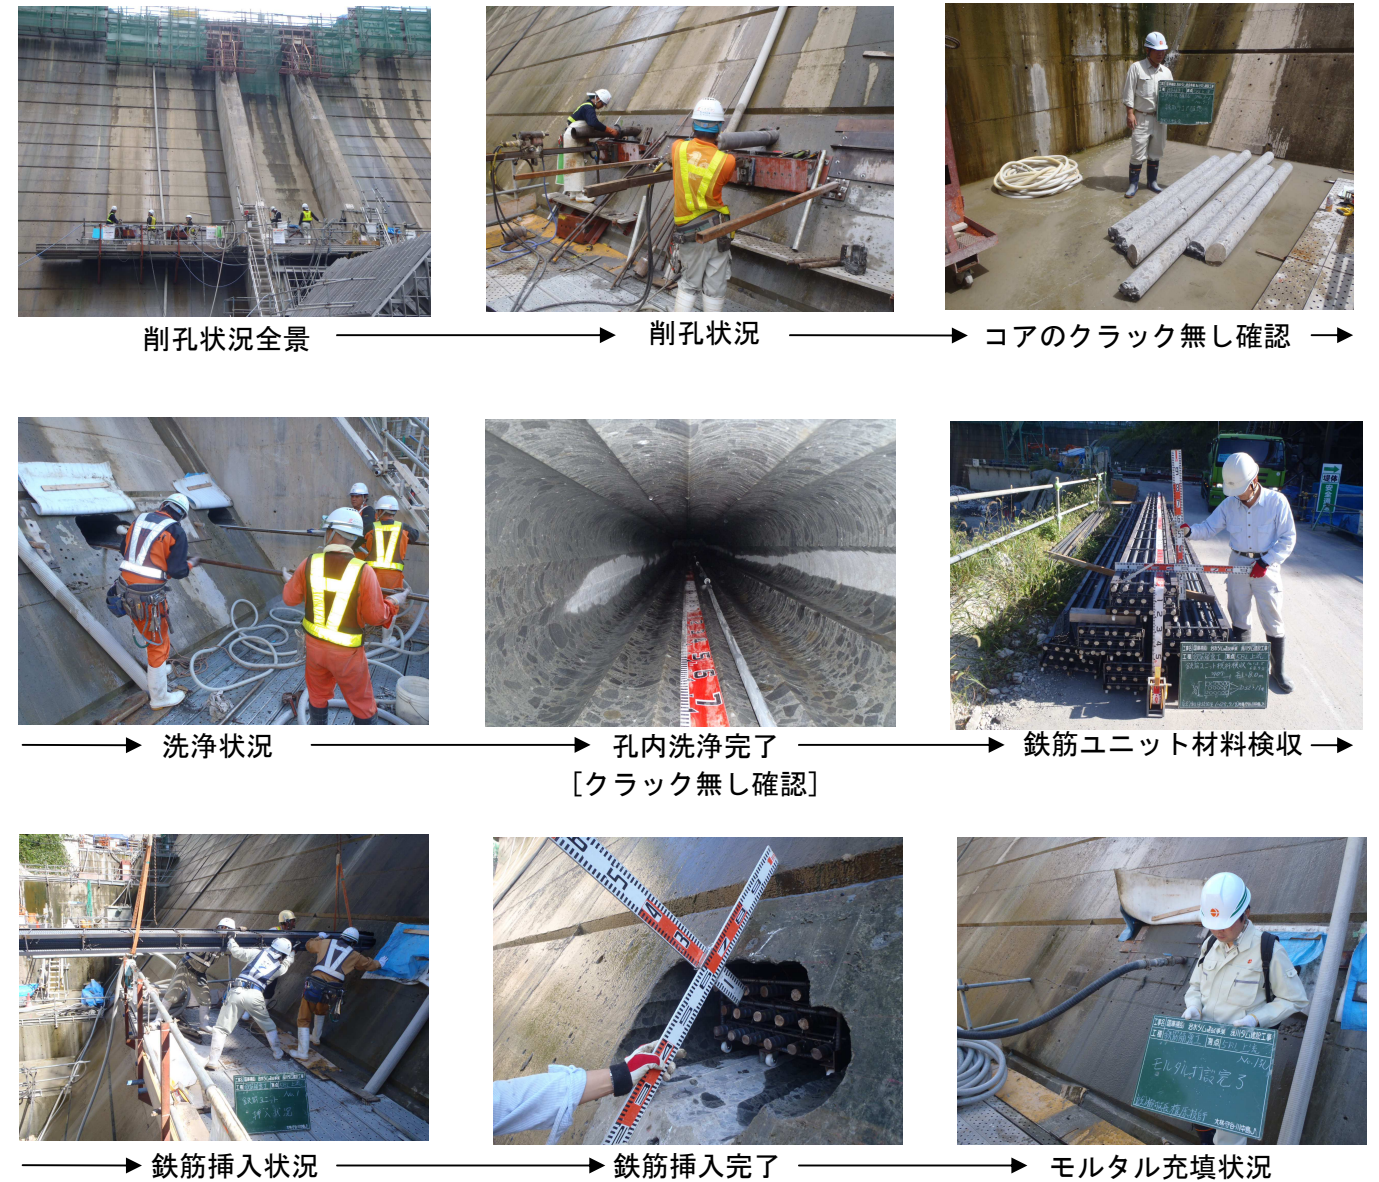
対策②上下流からの補強鉄筋工施工状況
